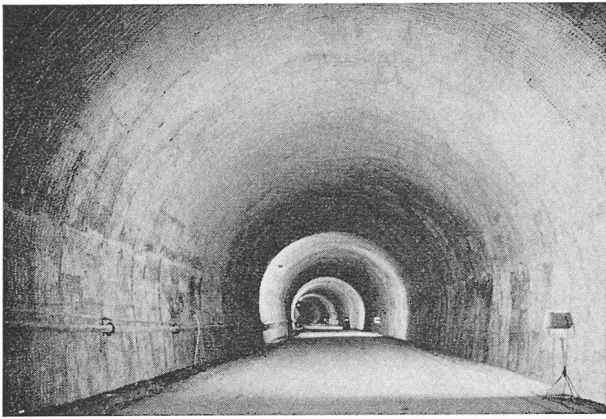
Tunnel du Flonzaley. Profil général avec revêtement en tôles Bernold.
